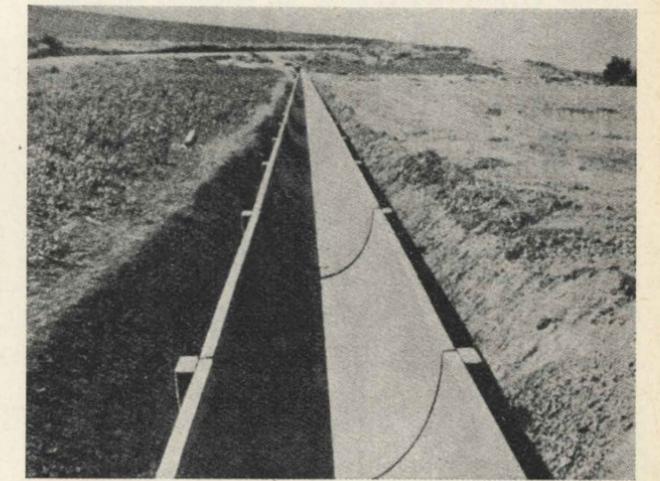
Canalette d'irrigazione (sistema S.T.U.P.).
